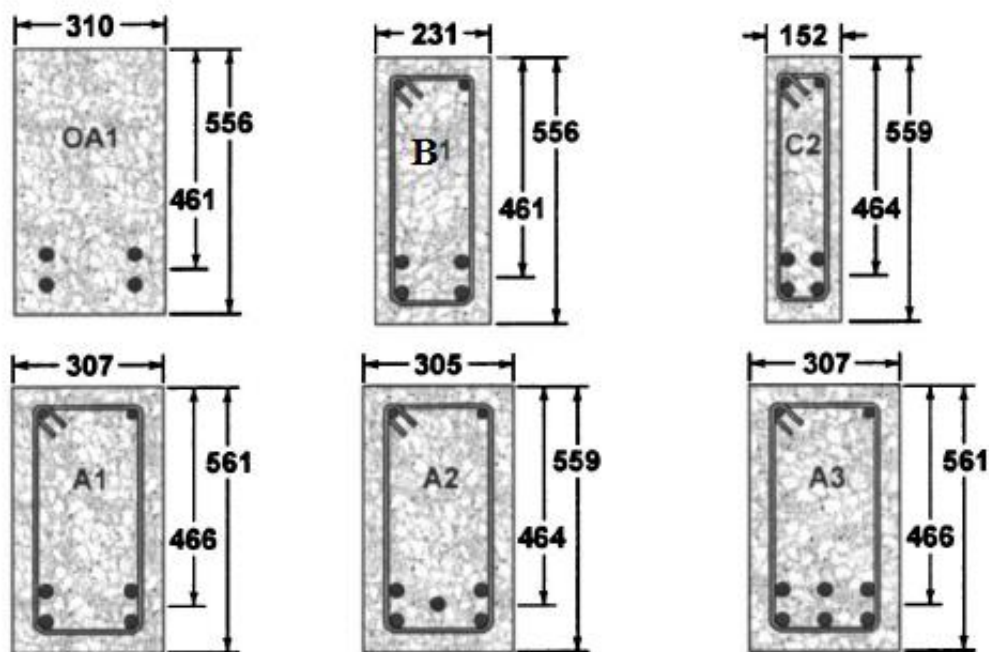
Seções transversais das vigas de Bresler & Scordelis (1963)
